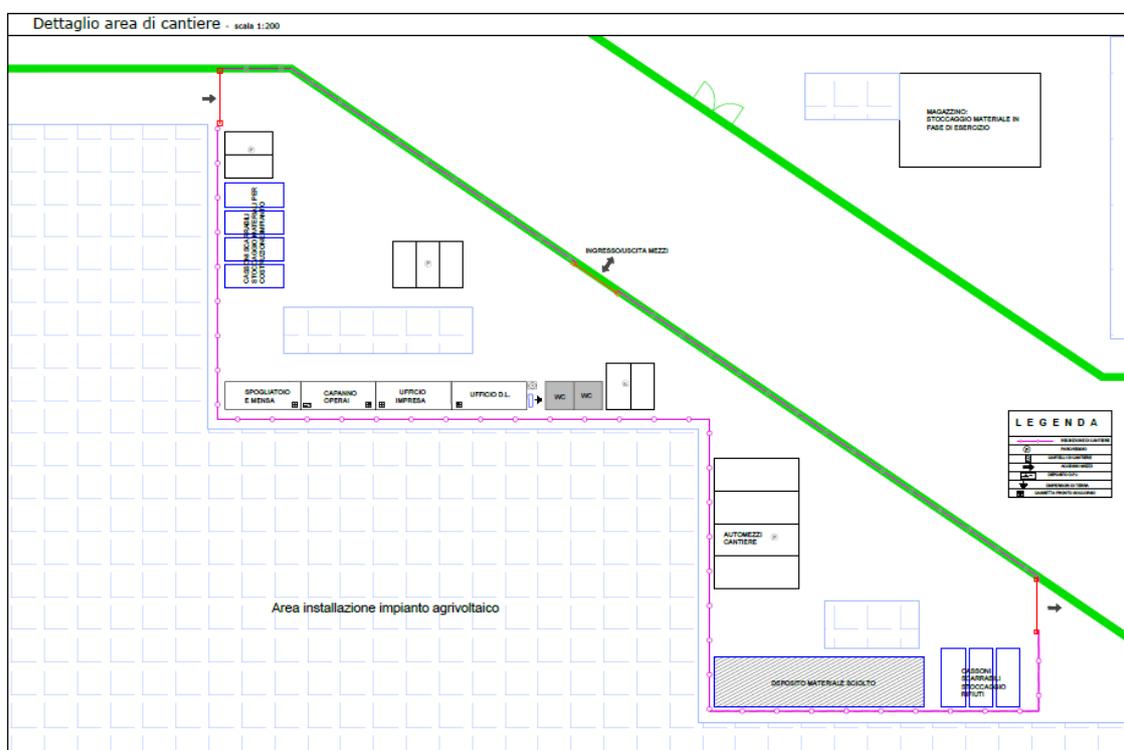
Stralcio Tavola "018_MRR-CIV-TAV-018_3di4_05 - Layout area di cantiere impianto agrivoltaico"
